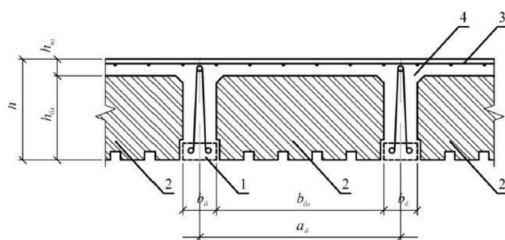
Сборно-моноклитное часторебристое перекрытие с пенополистирольными блоками в разрезе: 1 – легкие железобетонные балки с пространственным арматурным каркасом и железобетонным основанием (элемент несъемной опалубки), 2 – несущие пенополистирольные блоки (элемент несъемной опалубки), 3 – арматурная сетка, 4 – моноклитные железобетонные участки, состоящие из плиты и верхней части железобетонных балок (ребер)
